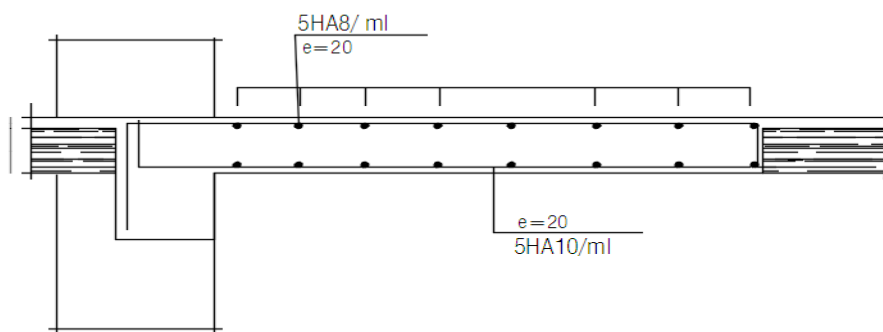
Plan de ferrailage de la dalle salle machine.
